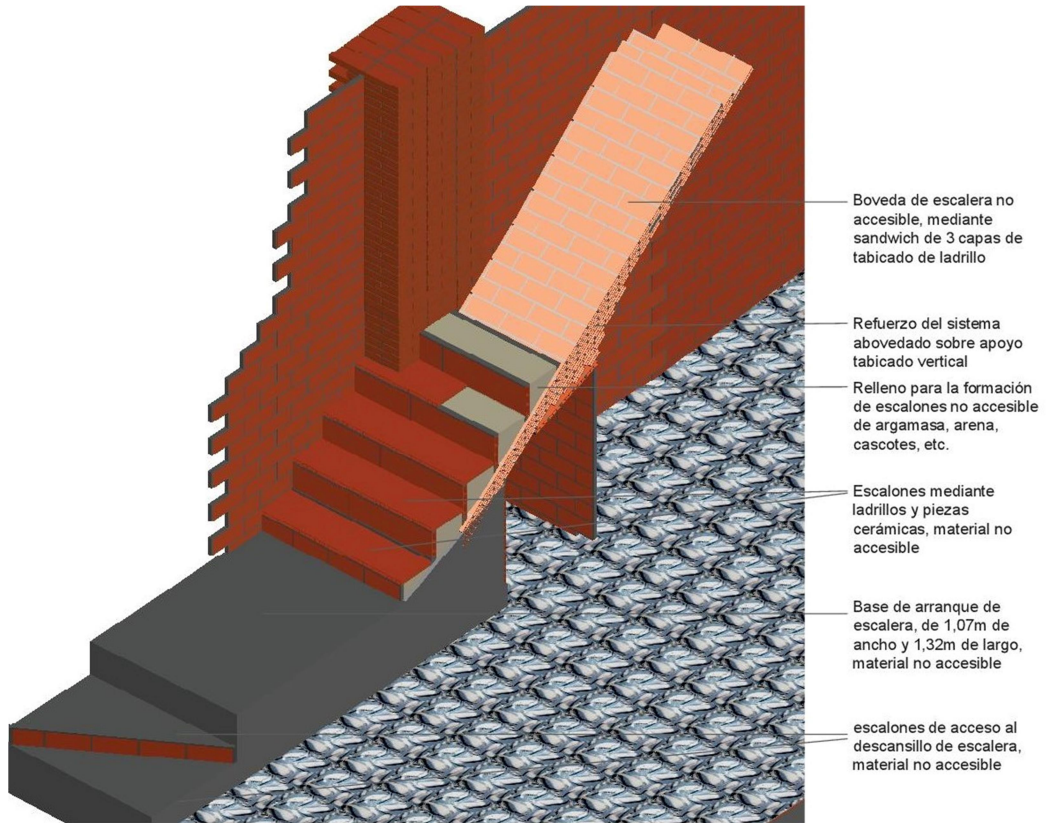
Detalle en secuencia constructiva del arranque de escalera
